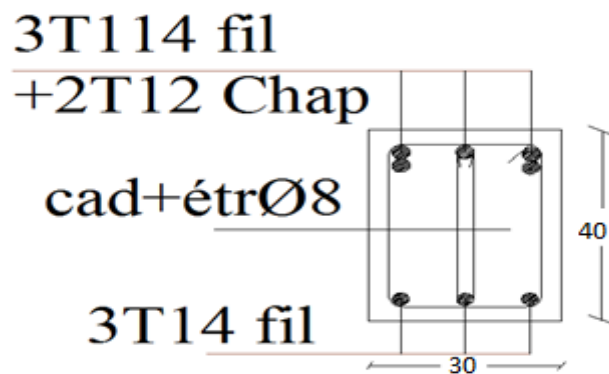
Exemple du ferrailage d'une poutre principale
